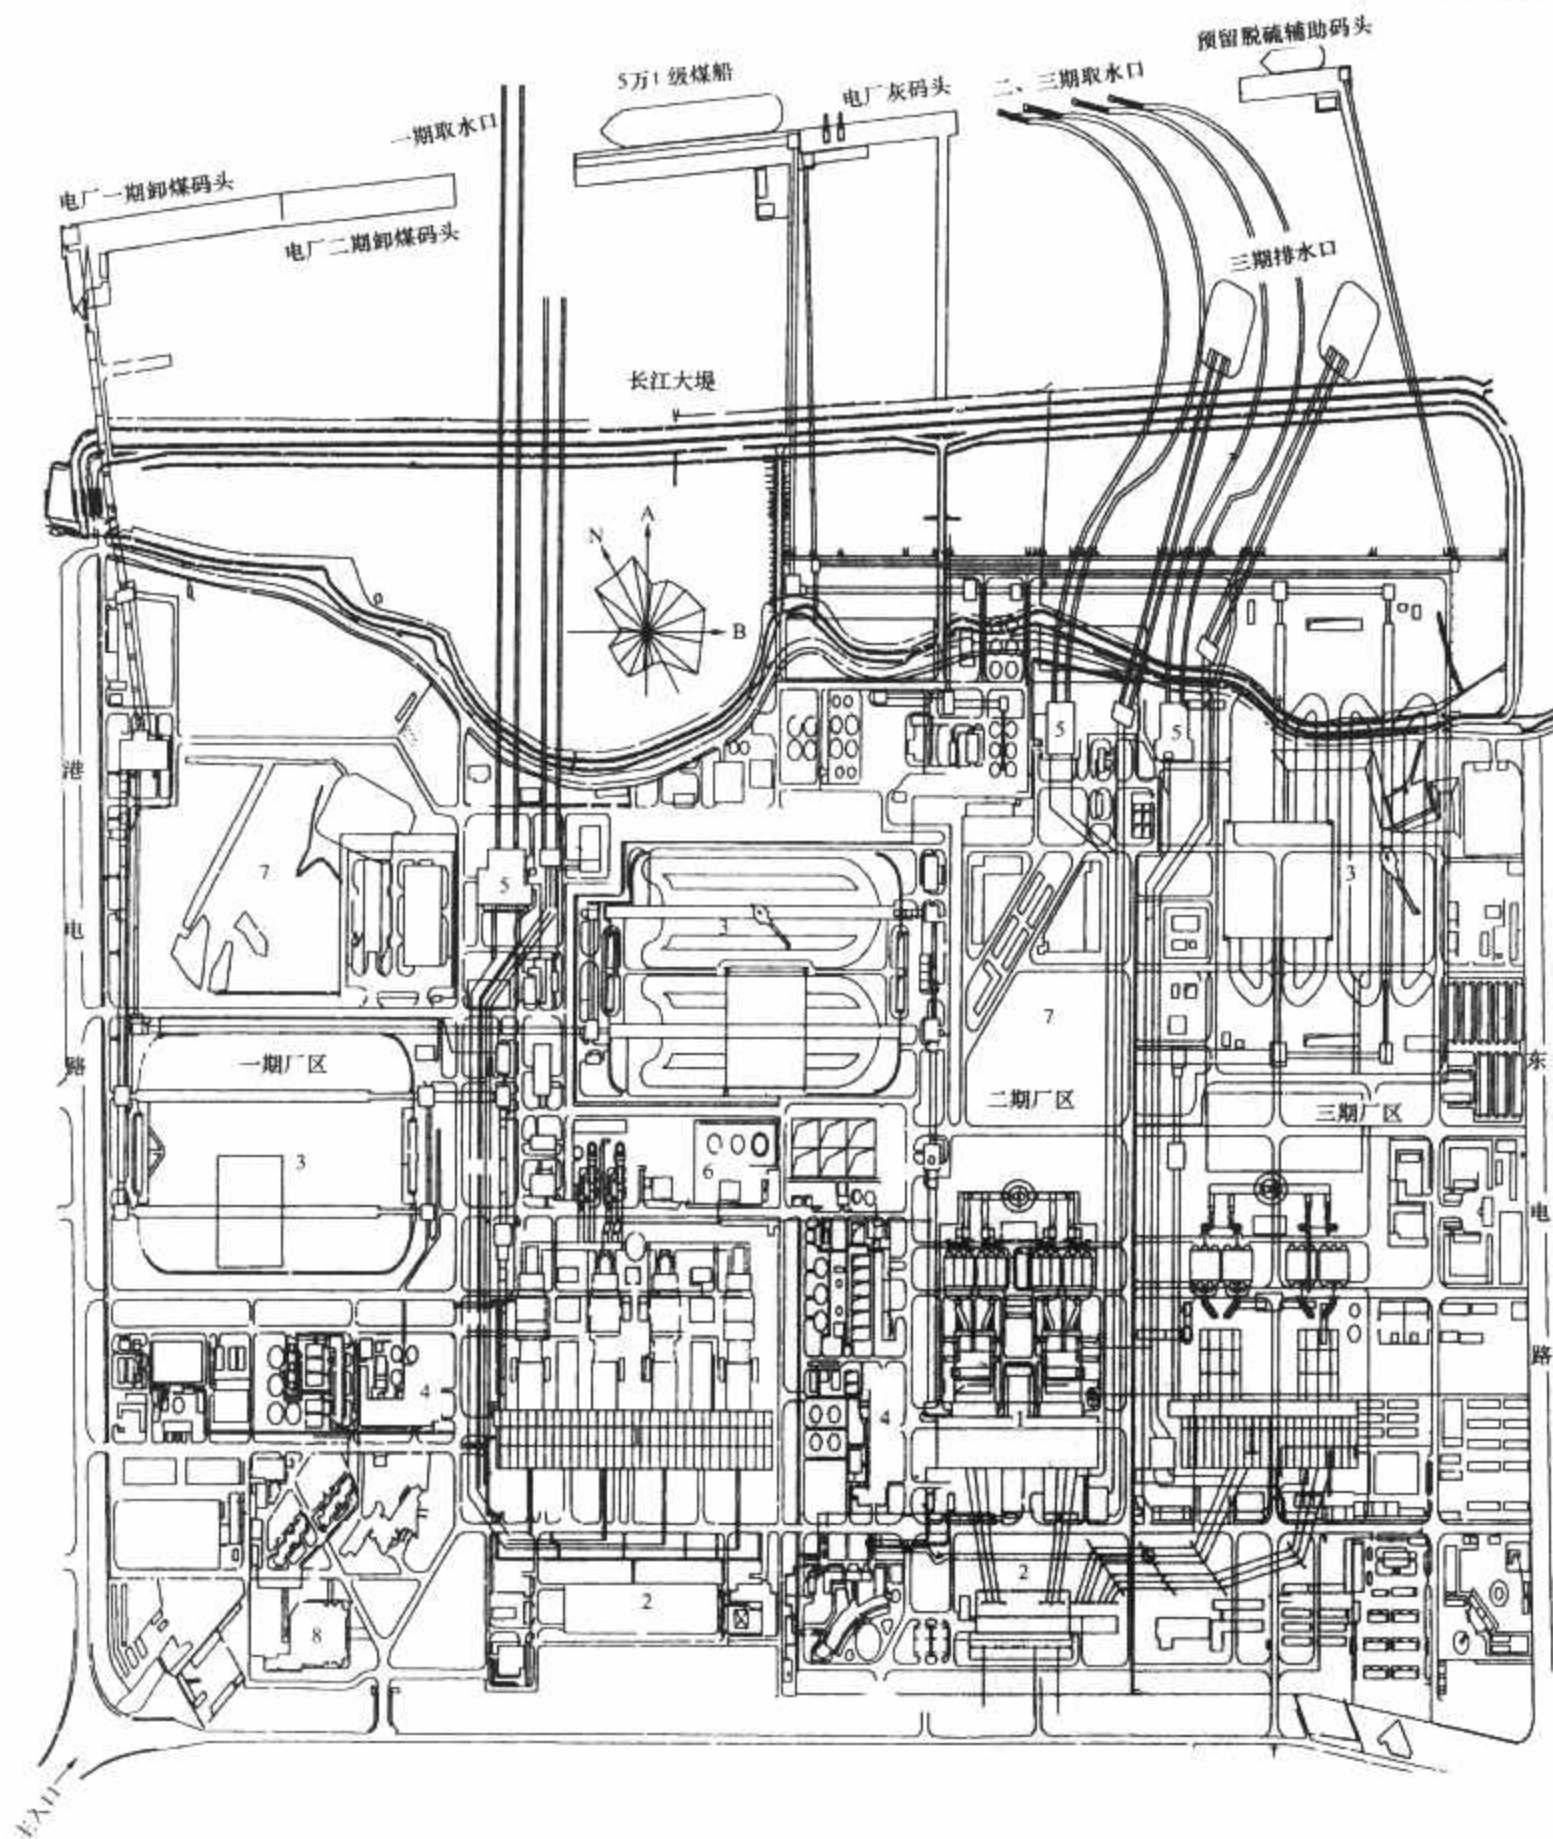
锅炉房面向水源的三列式电厂总平面布置图
